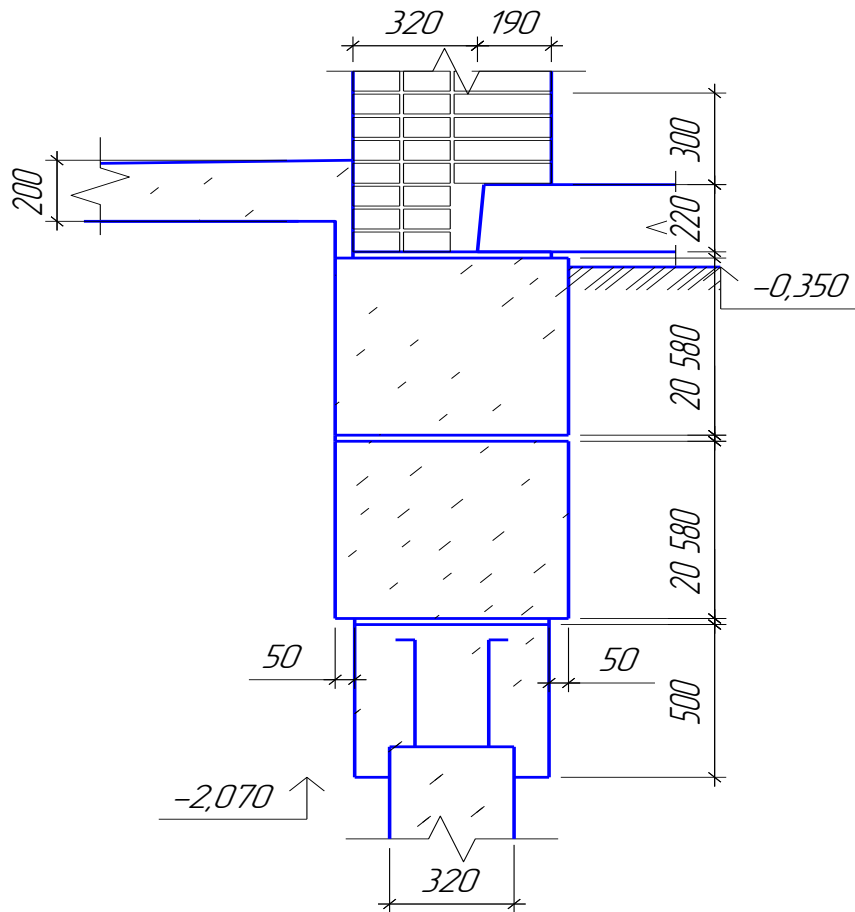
Узел сопряжения фундамента с несущими конструкциями
